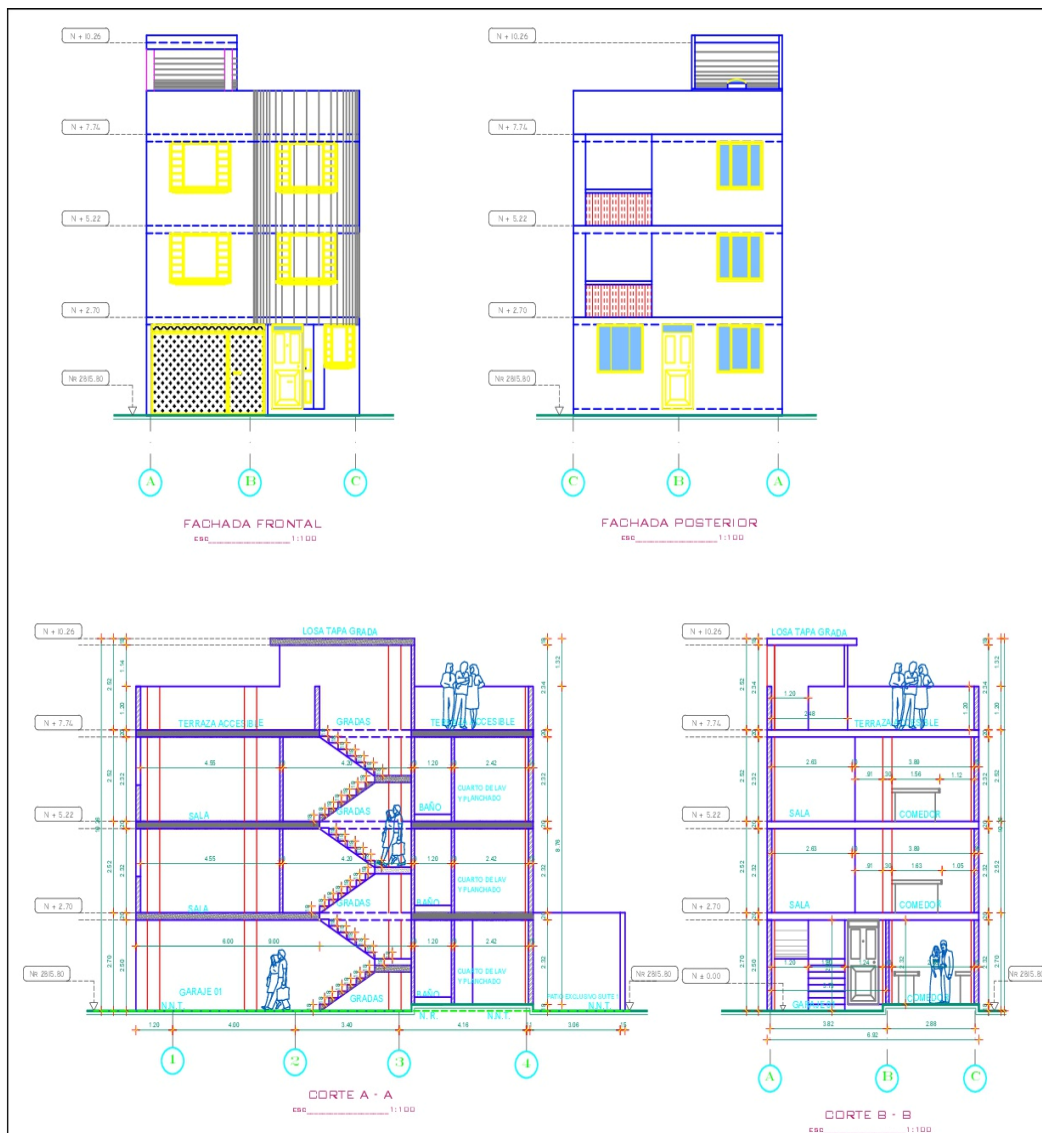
Cortes y Fachadas arquitectónicas de implementación del proyecto base.
